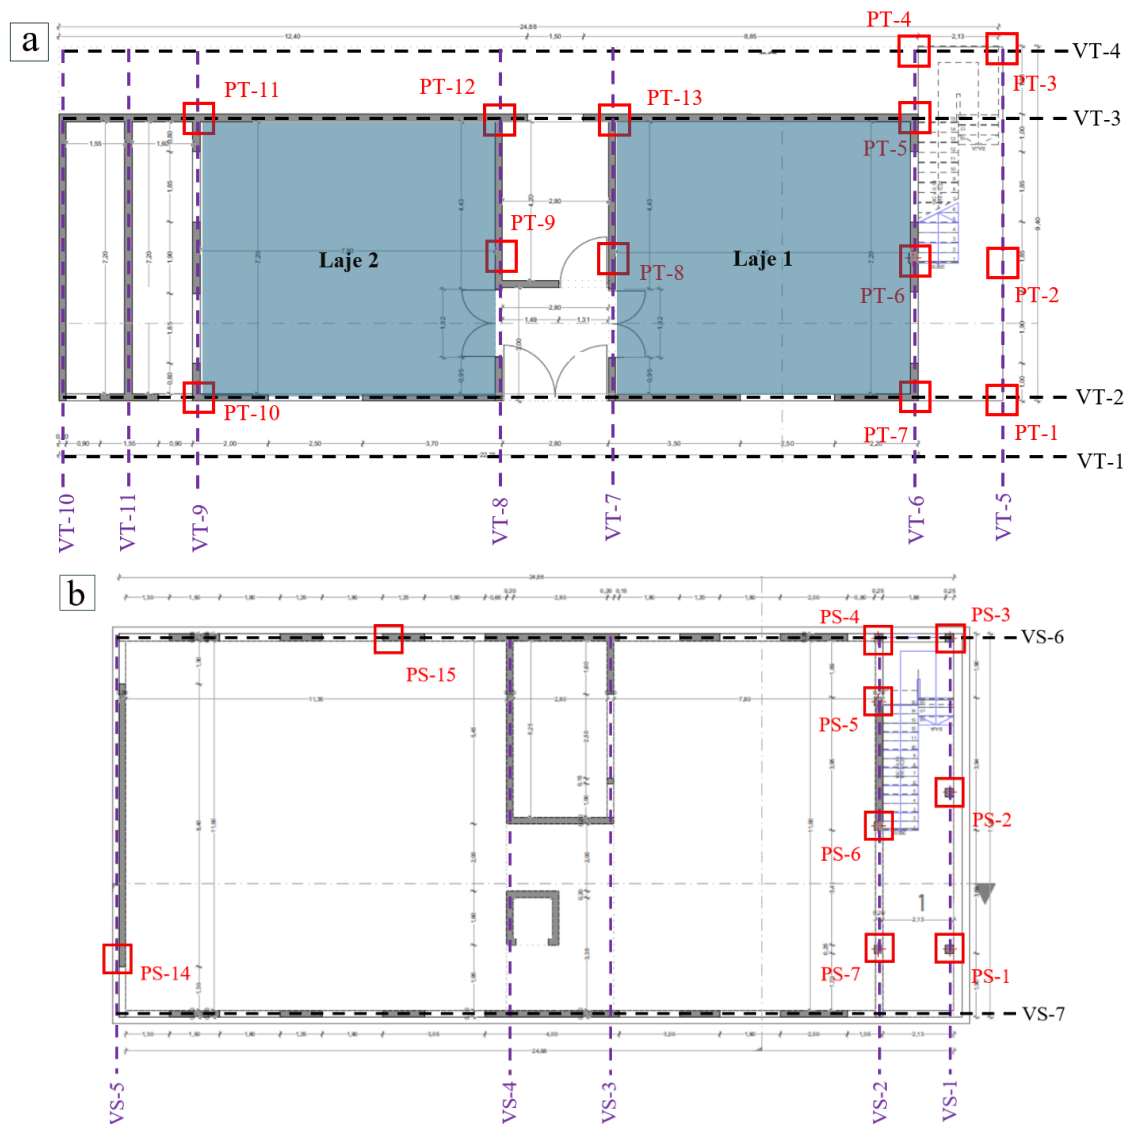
Planos da edificação: (a) pavimento térreo e (b) pavimento superior.
